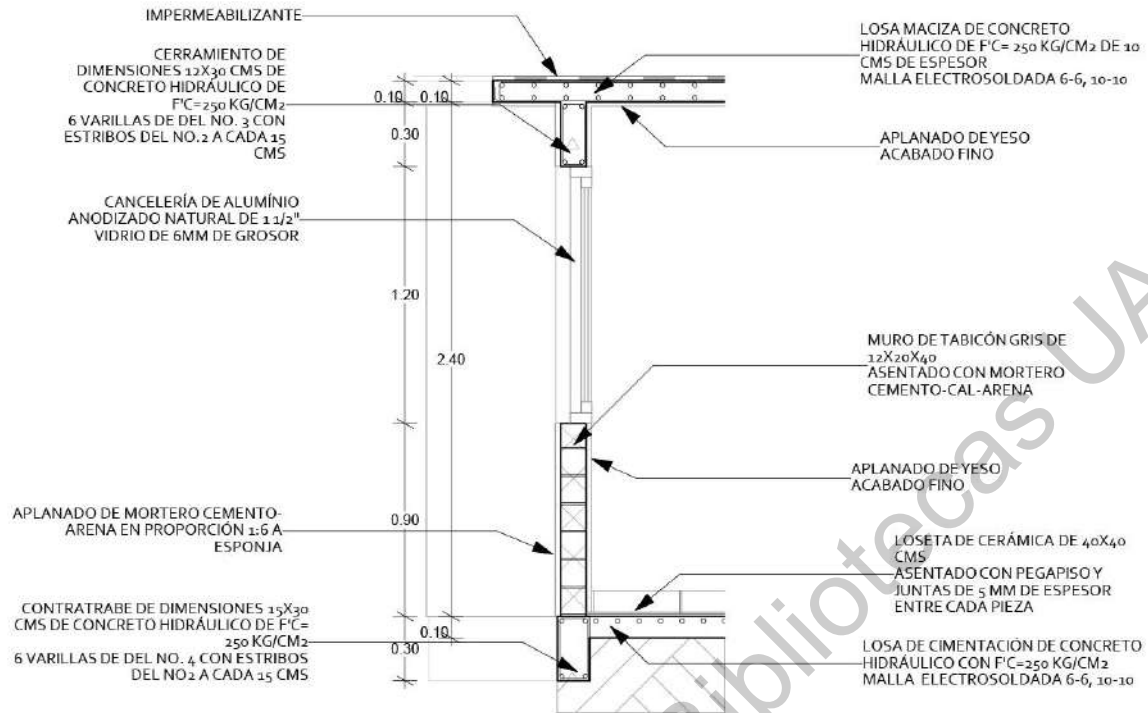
Corte por fachada de muro exterior - muro interior. Elaboración propia.
